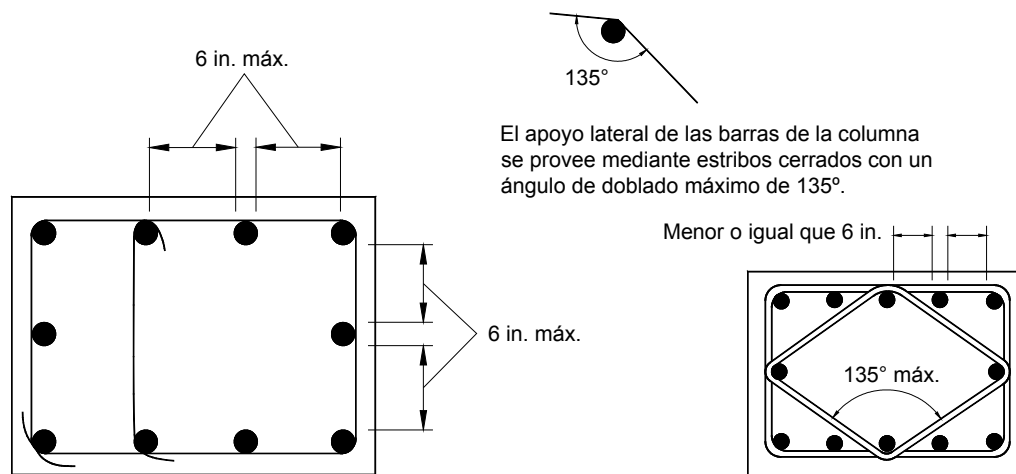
Esquemas de distribución de las barras longitudinales en las columnas
